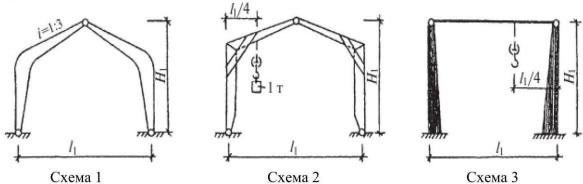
Схемы поперечных рам одноэтажного каркасного здания
